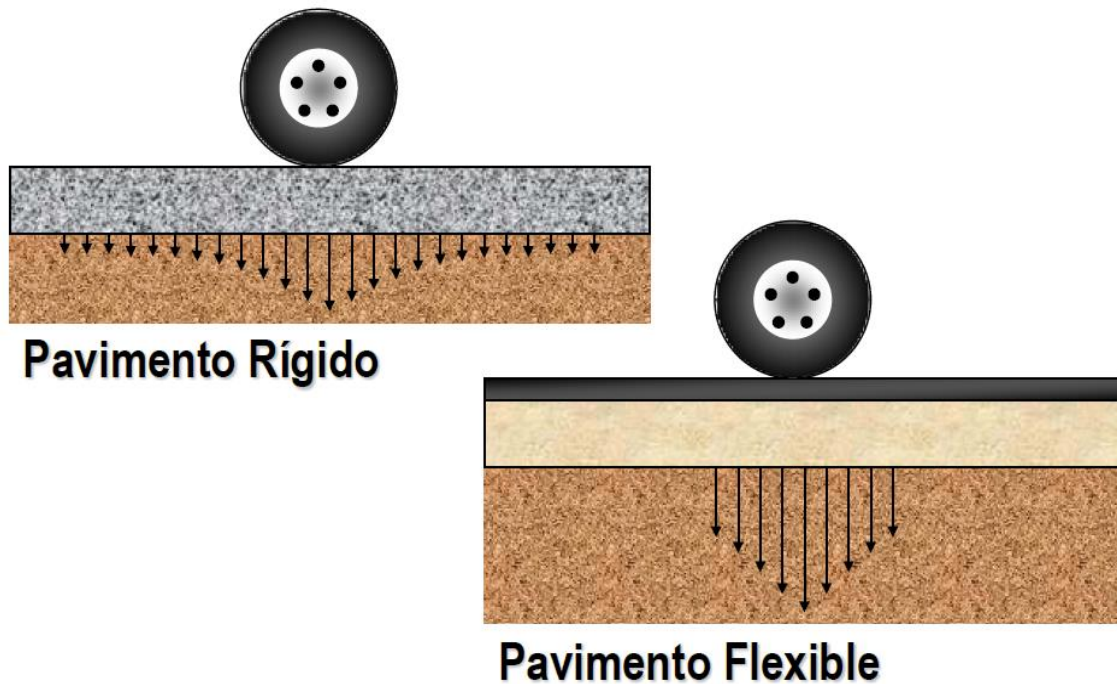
Comparativa de distribución de esfuerzos entre Pavimentos Rígidos y Pavimentos Flexibles.
